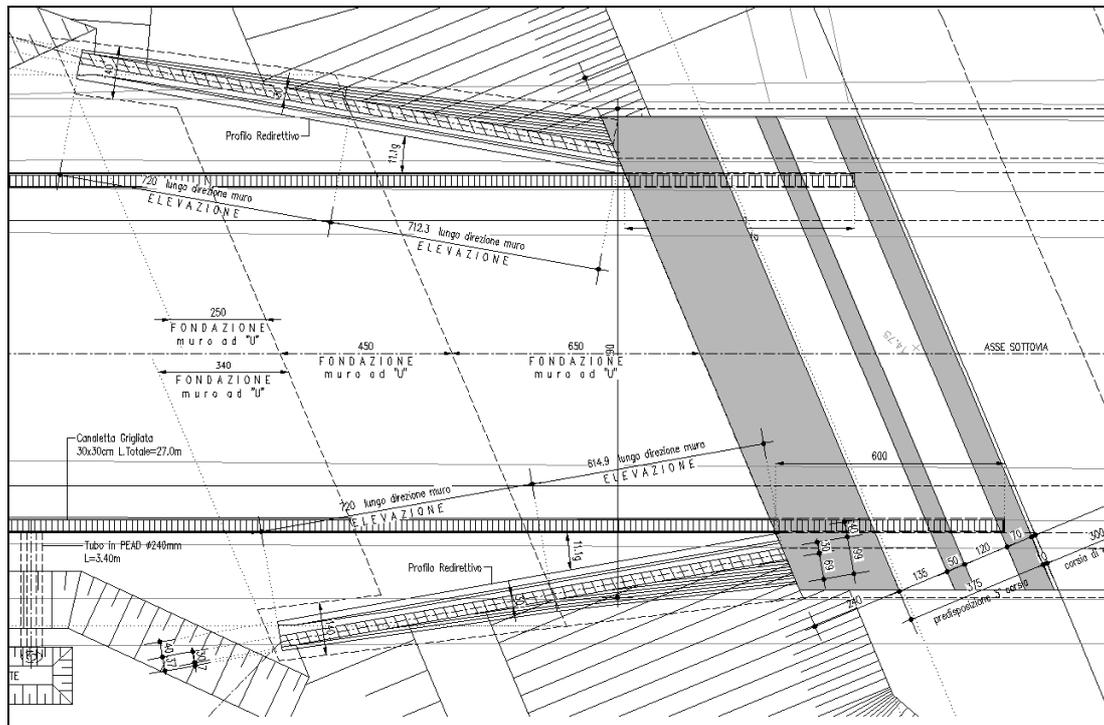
PARTICOLARE ALLARGAMENTO PLANIMETRICO DELLE ELEVAZIONI
